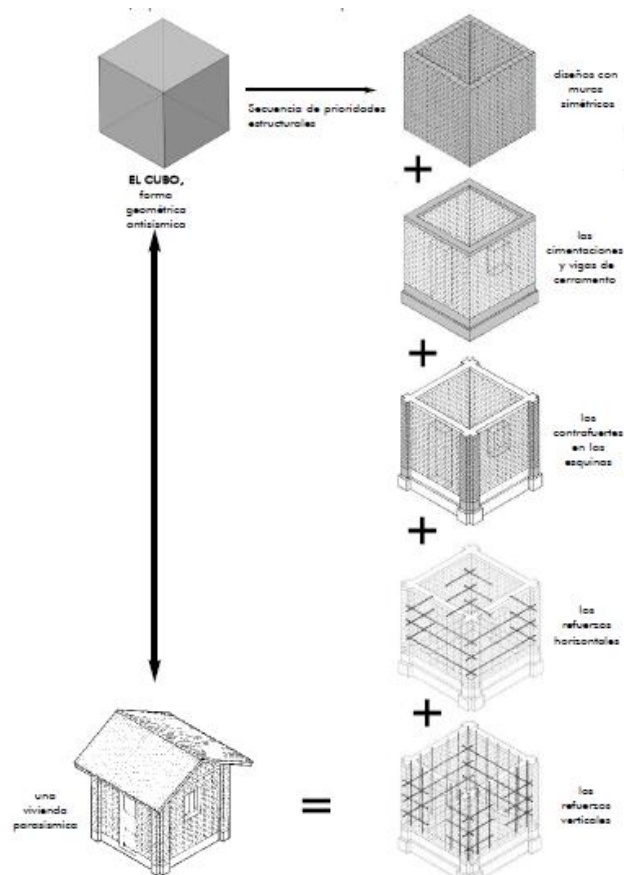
Geometría en forma de cubo. Fuente: (Carazas, 2002)
